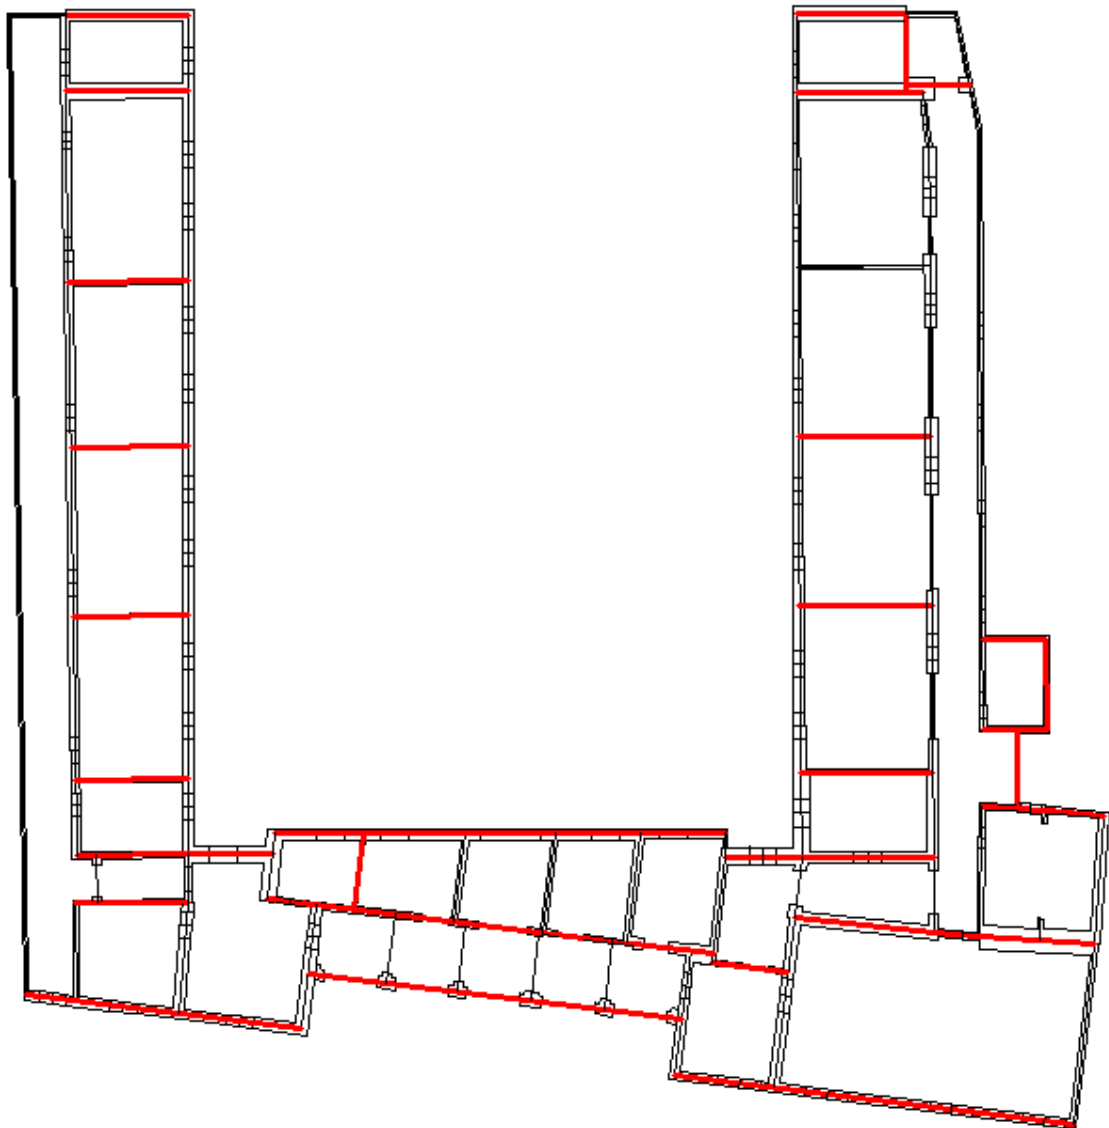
Posizione in pianta delle pareti sottoposte all'intervento con intonaco rinforzato con rete in GFRP.
